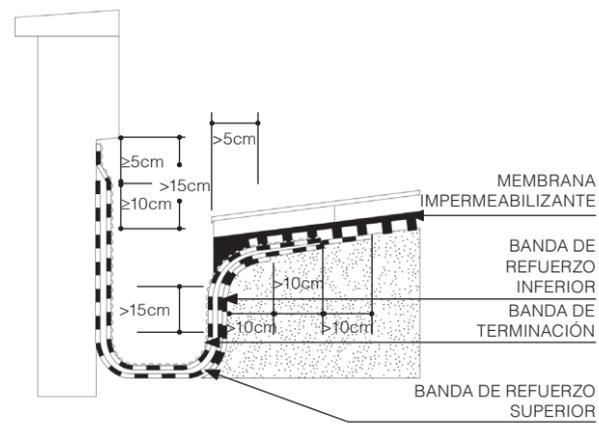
Detalles de canales de aguas lluvia con retorno con impermeabilización bajo protección de cubierta
